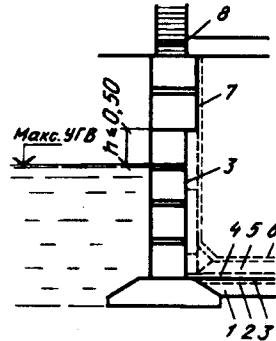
Гидроизоляция подвала при больших напорах грунтовых вод, устраиваемая по внутренней поверхности стен
